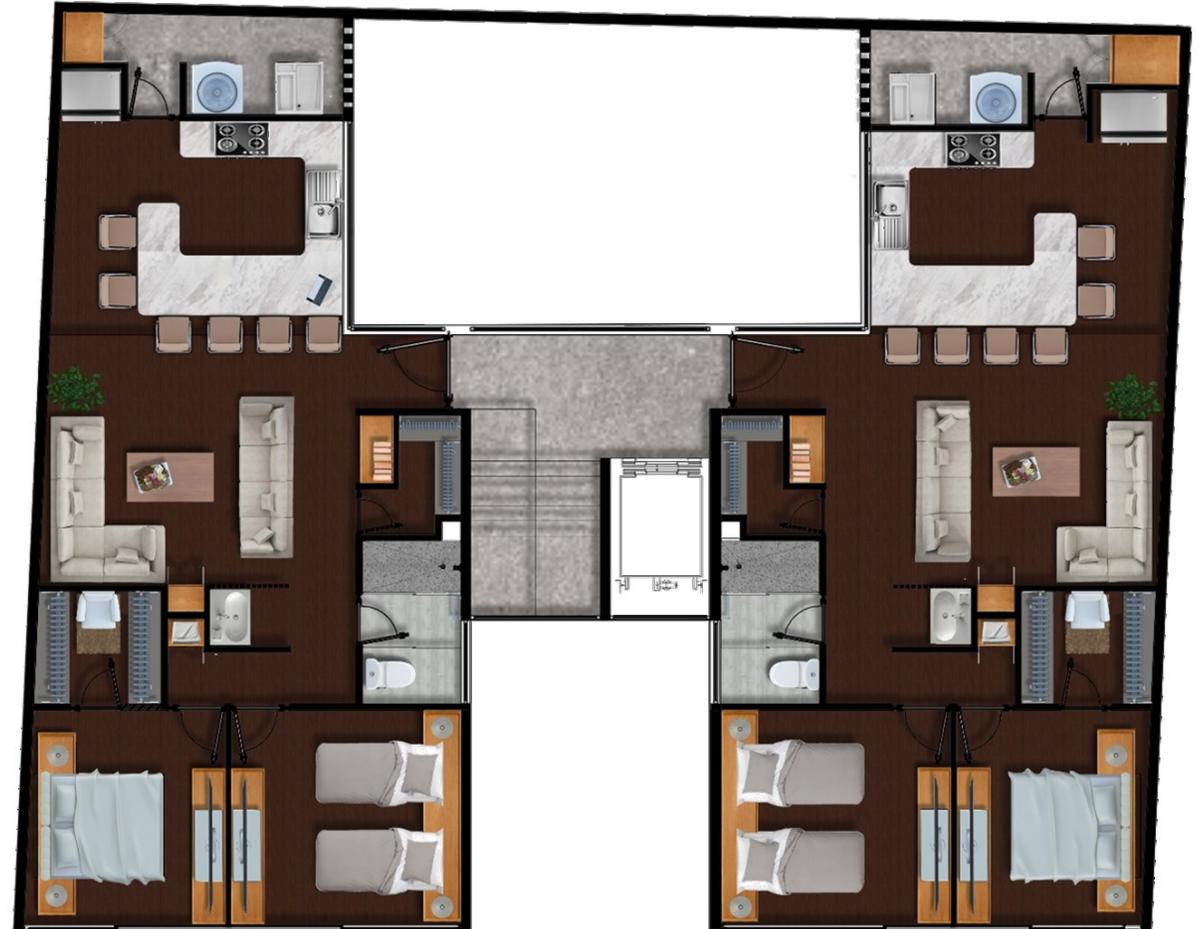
planta departamento tipo "A" propuesta arquitectónica de reconstrucción
